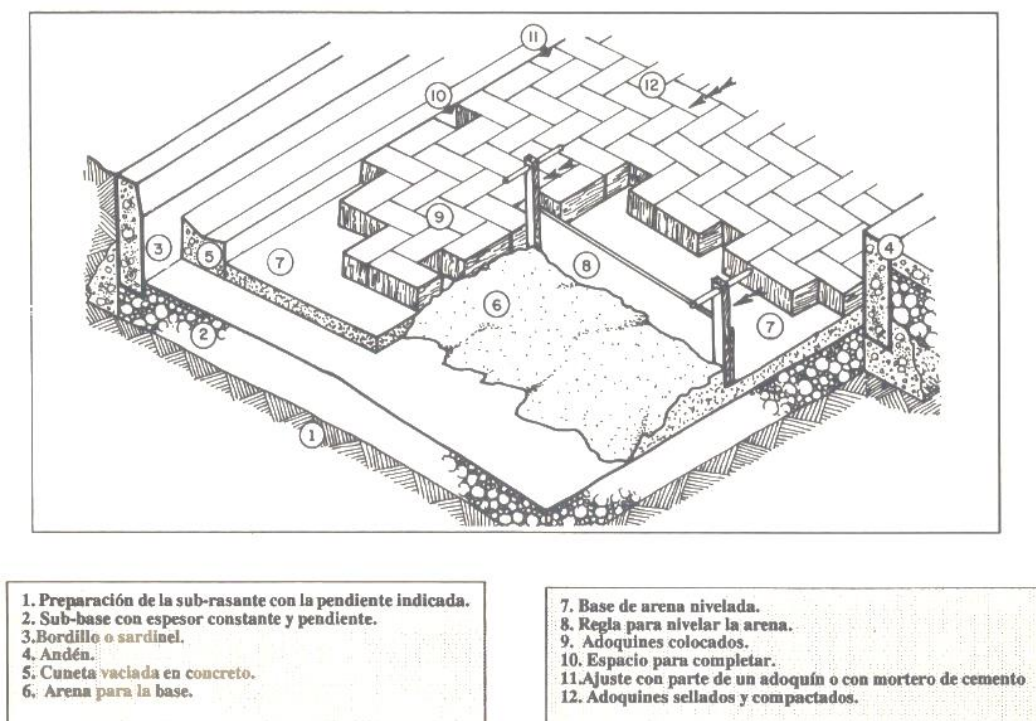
Identificación de elementos necesarios para construcción de pavimento articulado. Fuente:
